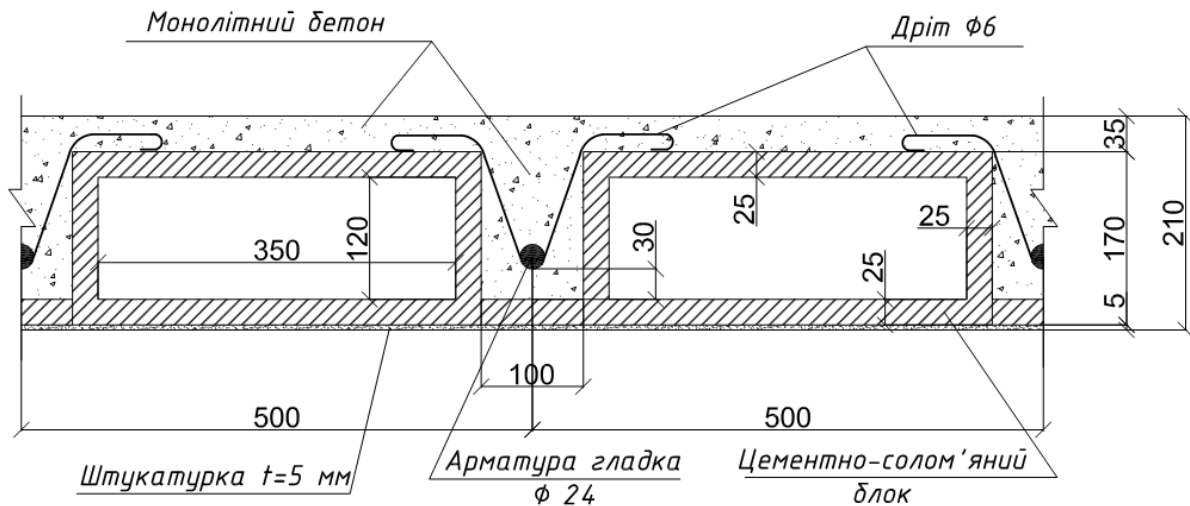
Конструкція збірно-монолітного перекриття 2-го поверху
